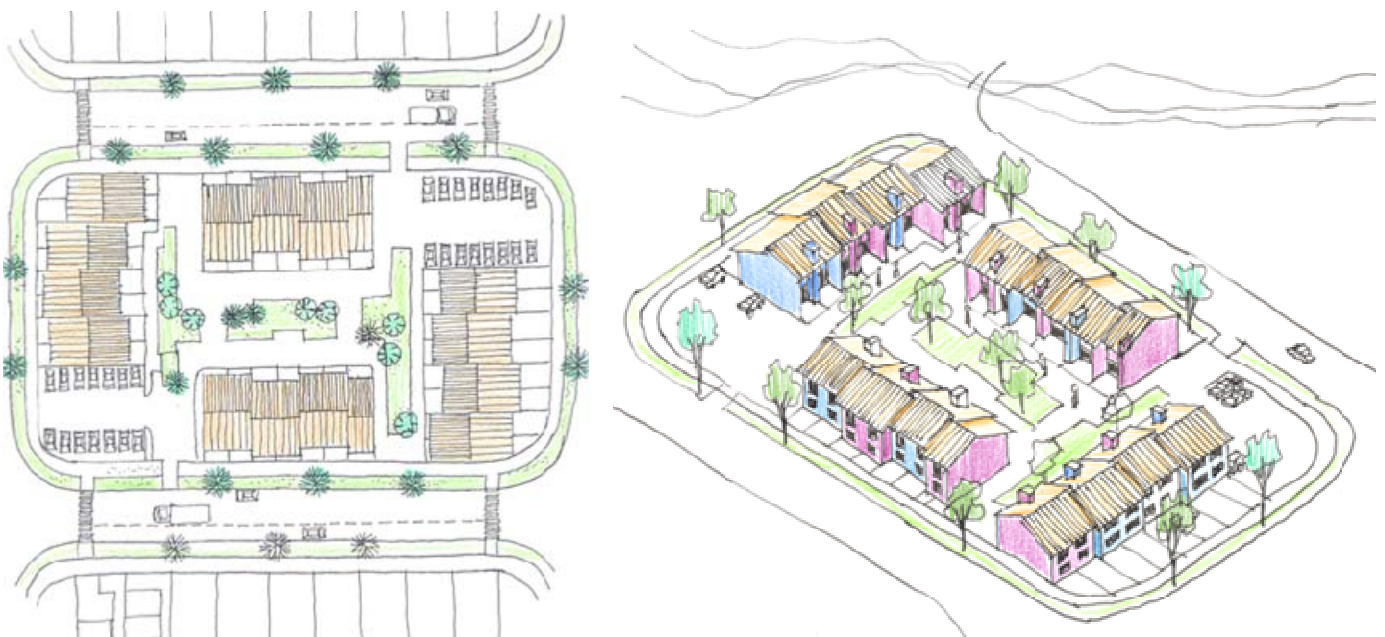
Implantação: planta e vista geral de um conjunto habitacional
